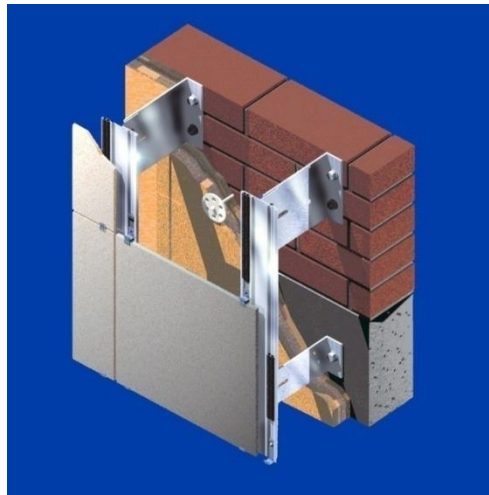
Конструкція стіни з вентиляваним фасадом
